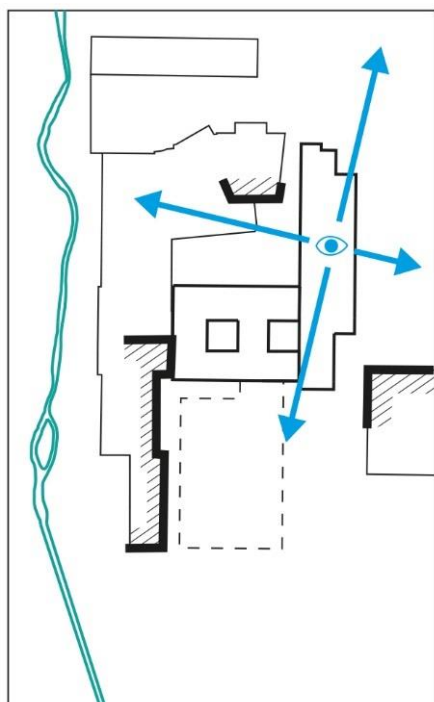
Illustrasjonsplan full utbygging alternativ 2
